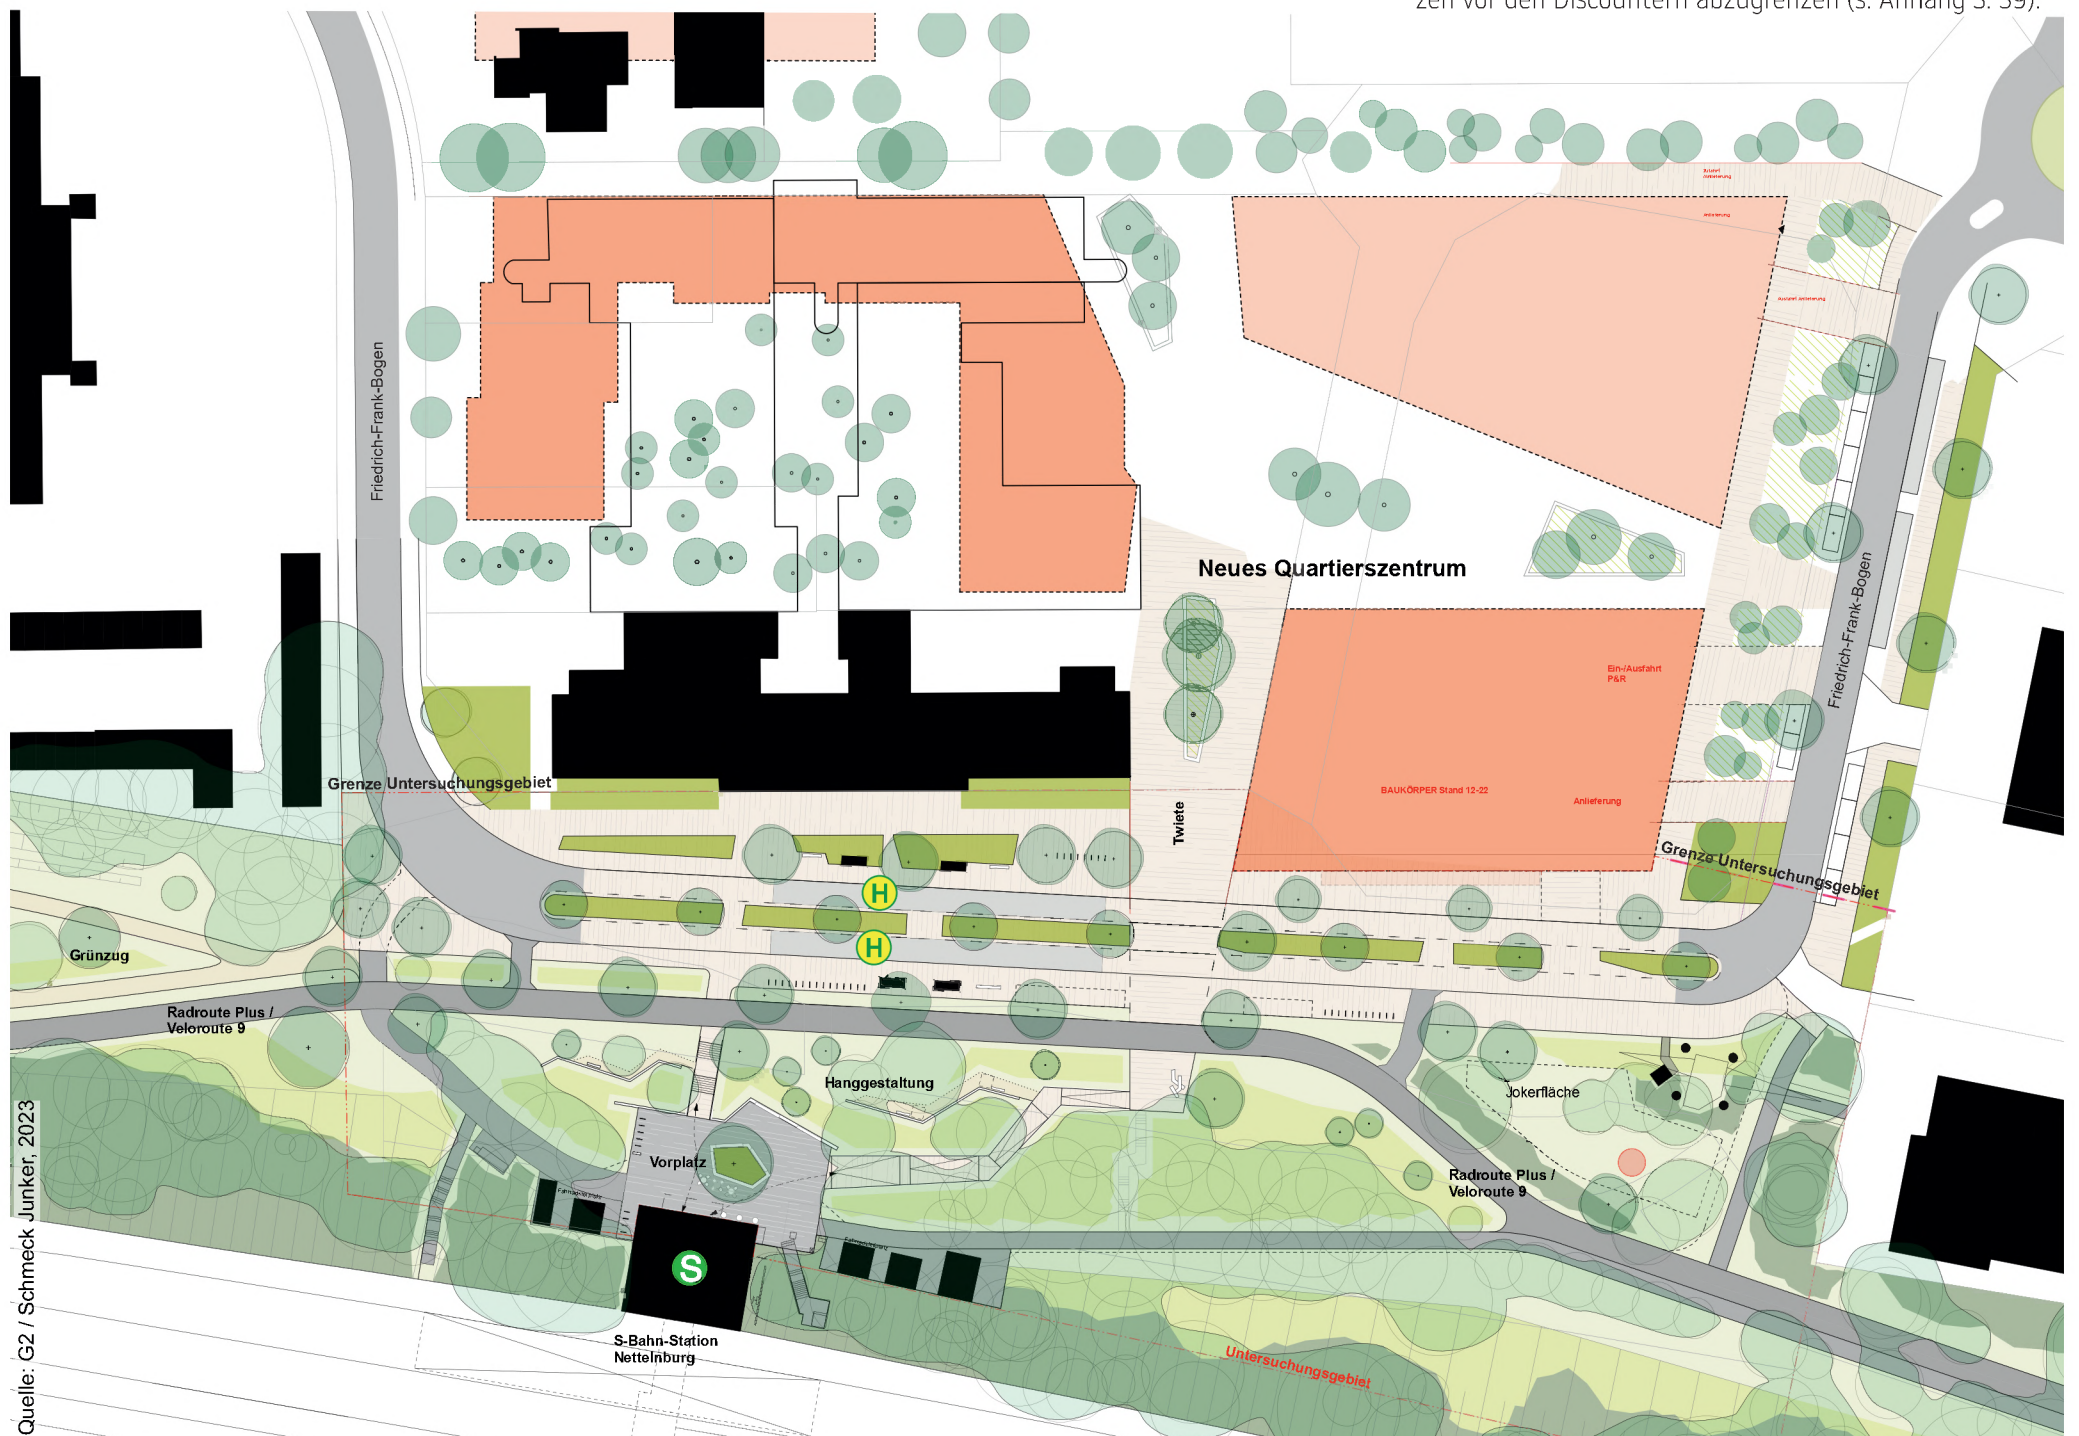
Lageplan Vorzugsvariante Gestaltungskonzept
